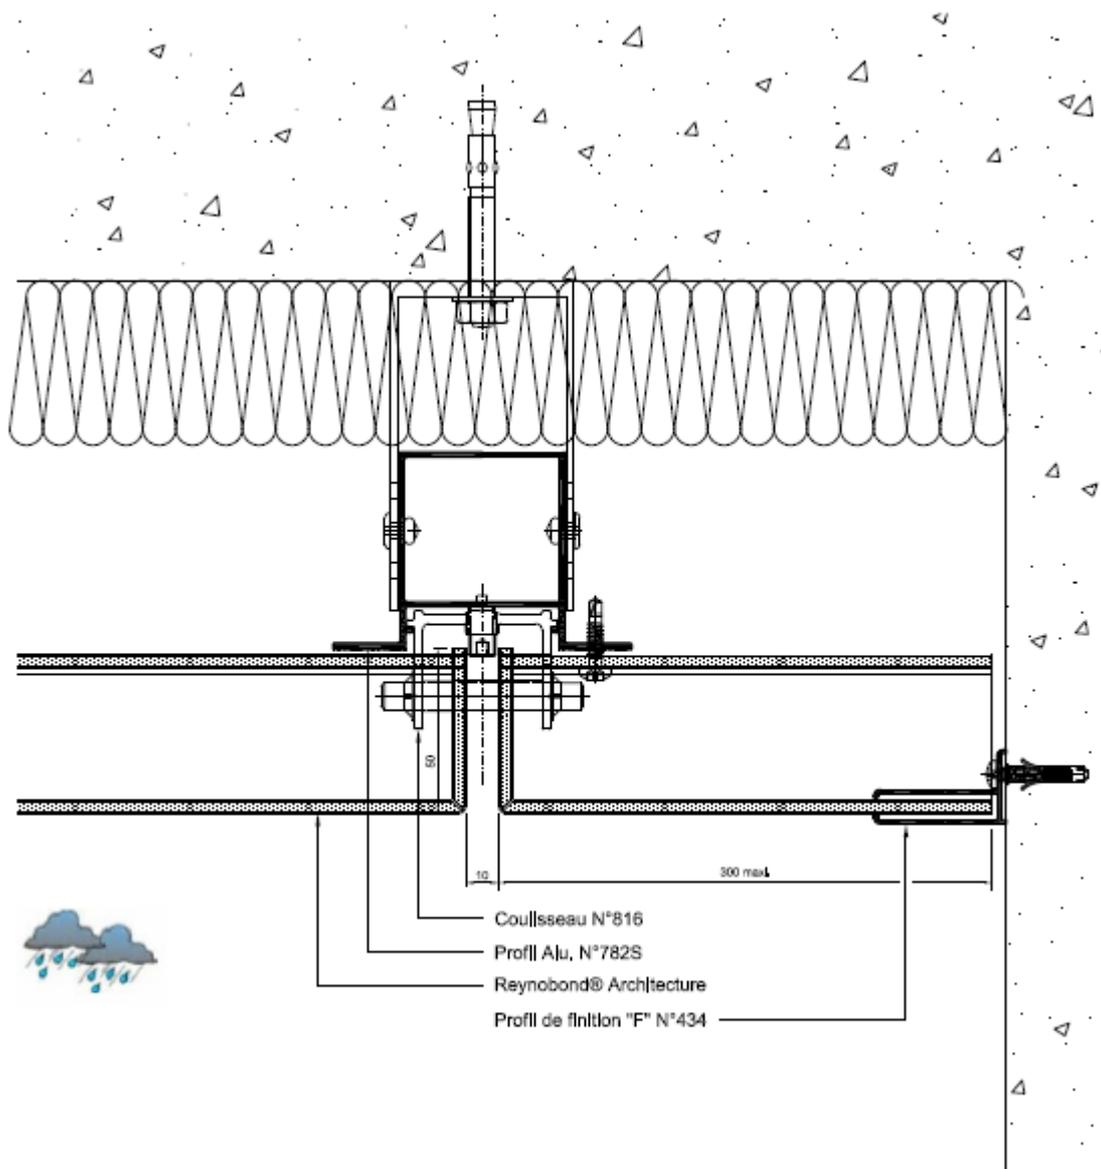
Raccord latéral – Coupe horizontale KU 50 VA
